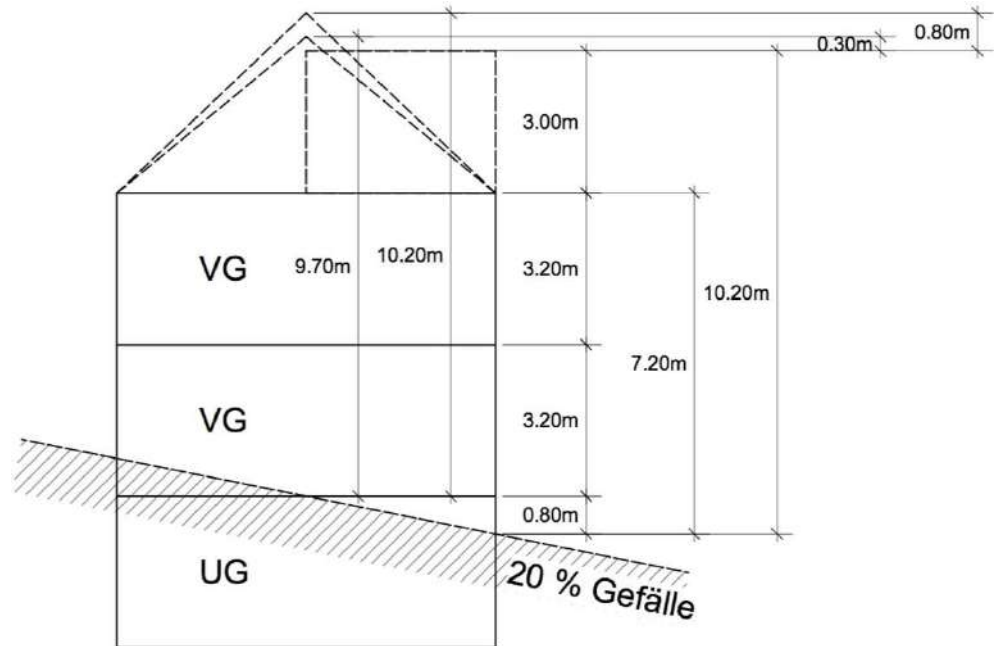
Vergleichsskizze Gebäude mit Schrägdach und Flachdachbau mit Attikageschoss am Hang
